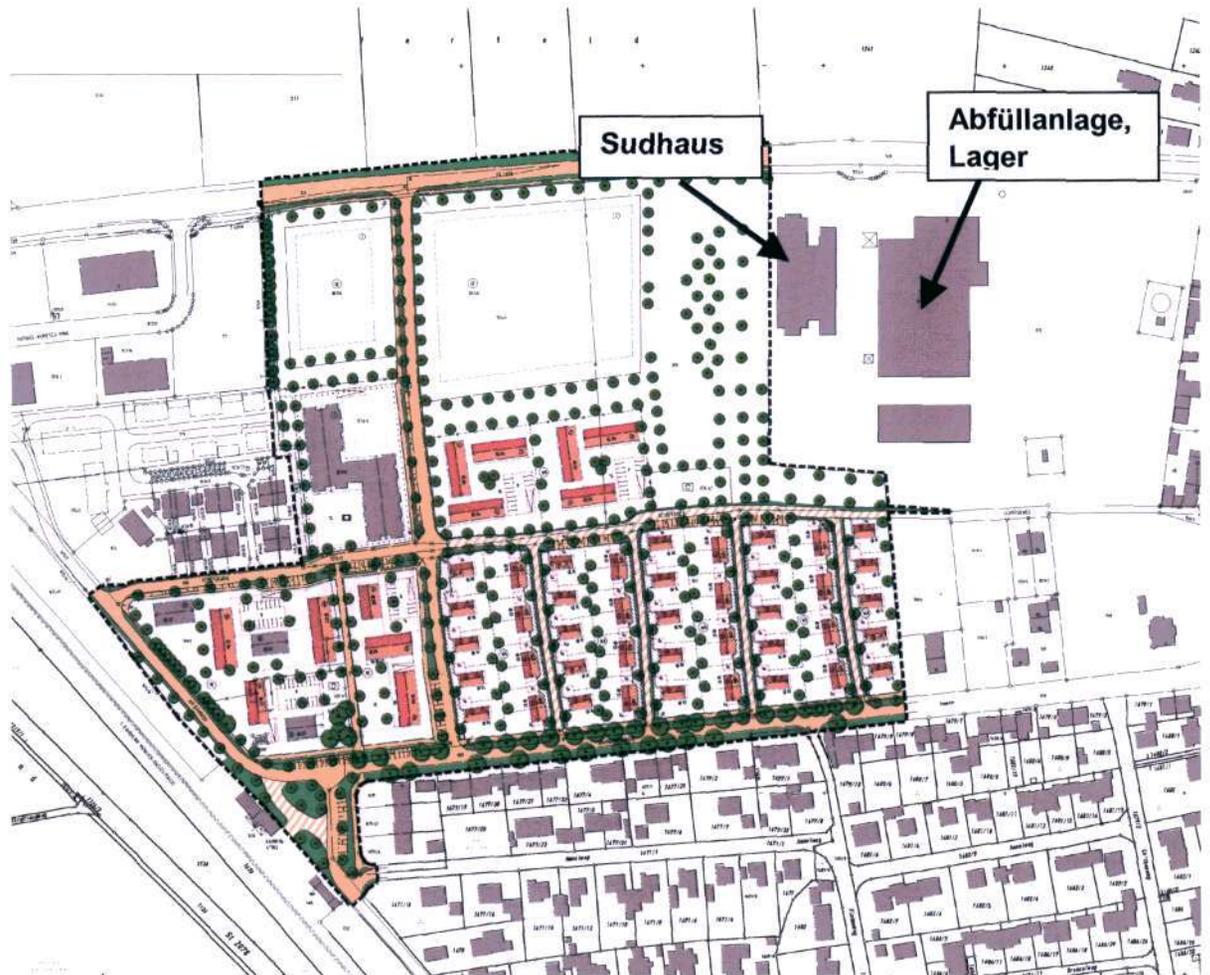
Lageplan (Auszug aus dem Bebauungsplan)
